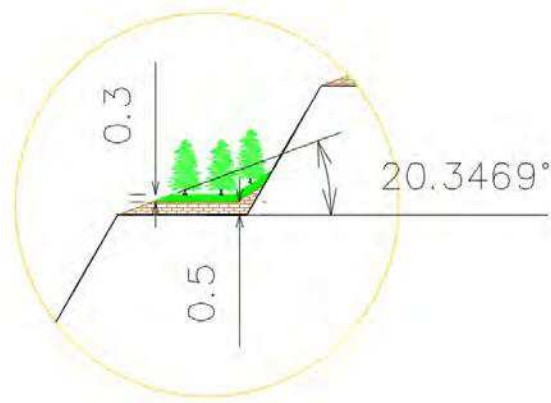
Esquema de plantación en un perfil de restauración con pinos a pie de los taludes más fuertes.
